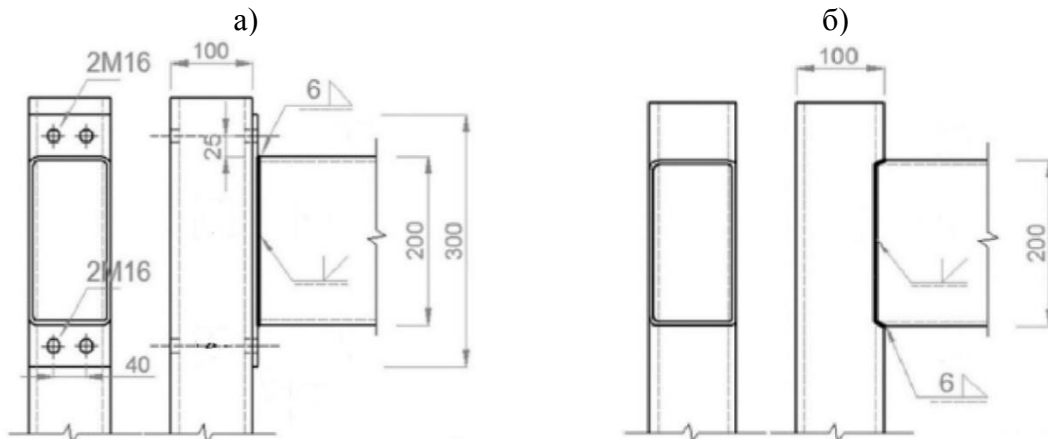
Типы внутримодульных соединений: а) на болтах [38]; б) на сварке [38]
